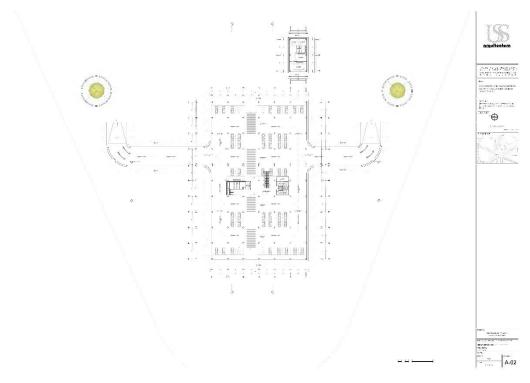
Planta Sótano-Proyecto Estación intermodal. Elaboración propia
